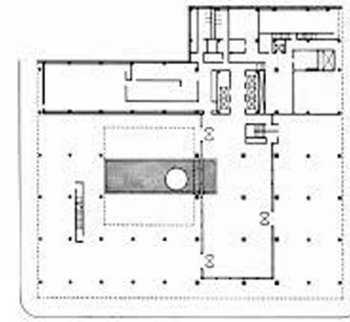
Edificio Lever House. Fuente: Plataforma Arquitectura
